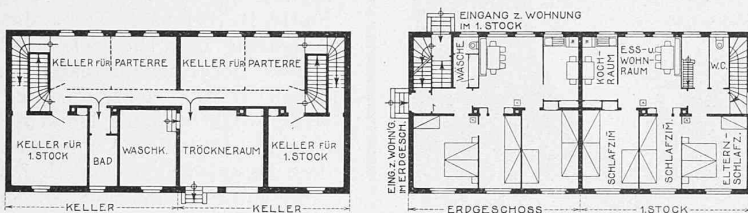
und 23. Grundrisse des nördlichen Doppel-Zweifamilienhauses. — 1 : 400.
